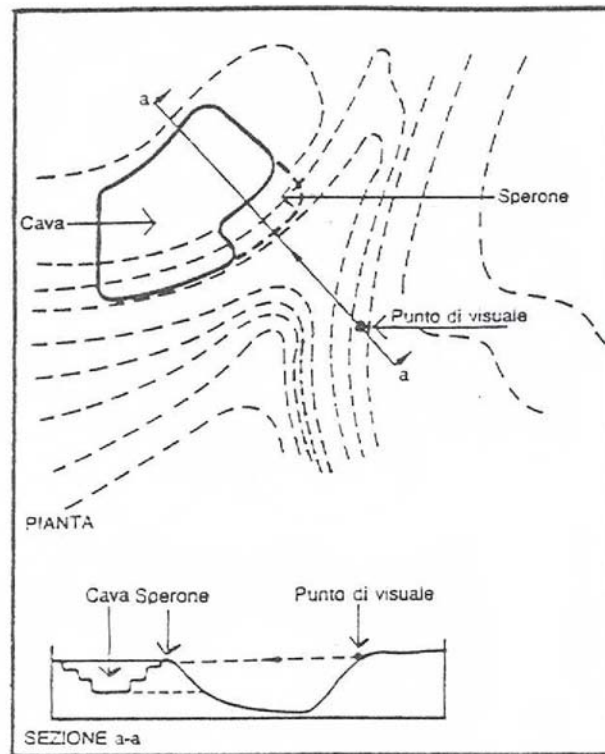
PIANTA E SEZIONE DI UNA CAVA CON LA PREVISIONE DI UNO SPERONE PARAVISTA
